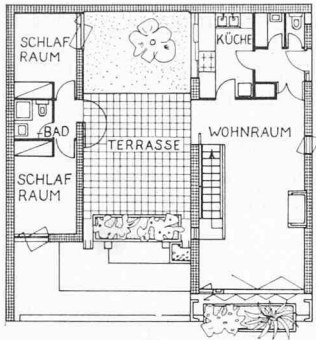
Grundriss 1:300 der Villa Typ B₁. Das Haus umfasst zwei Niveaux (das erste Niveau entspricht dem Typ C), 128 m² Wohnfläche und kostet einschliesslich Land usw. 350 000 NF
